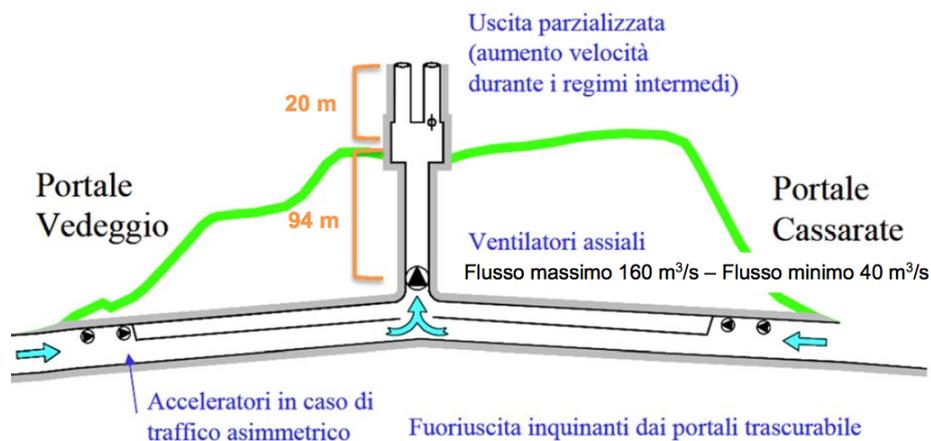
struttura del camino e dati tecnici riguardanti il sistema di ventilazione della galleria Vedeggio-Cassarate
